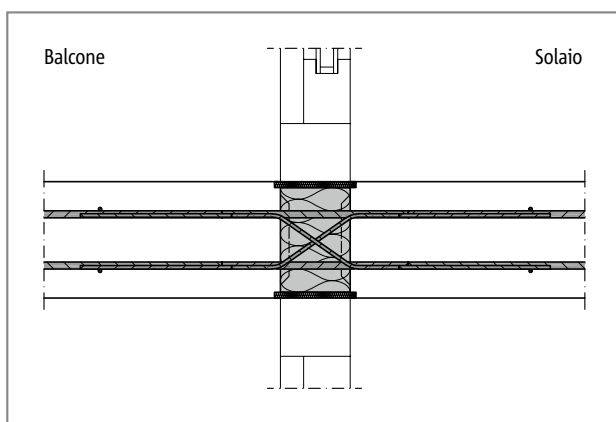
Schöck Isokorb® XT tipo D: sezione costruttiva; solaio monodirezionale
